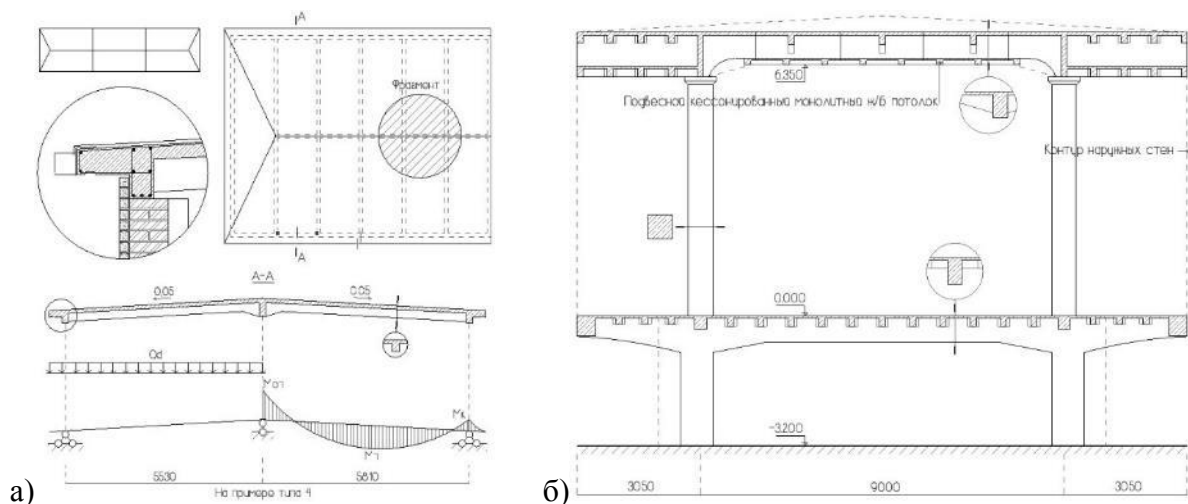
а) – конструкция покрытия многоквартирного жилого дома, пролет до 6 м), б) – зрительного зала здания Клуба (бывш. Дома офицеров), пролет 9 м, консольный участок ок. 3 м
